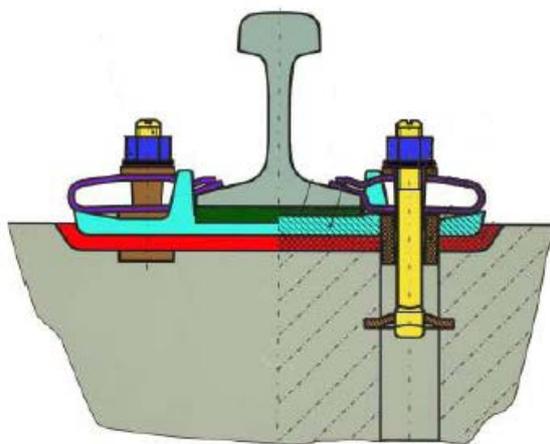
Упругое нераздельное рельсовое крепление с пластинчатыми пружинными клеммами для железобетонных шпал, и подкладка, и клеммы крепятся к шпале при помощи анкерных болтов
